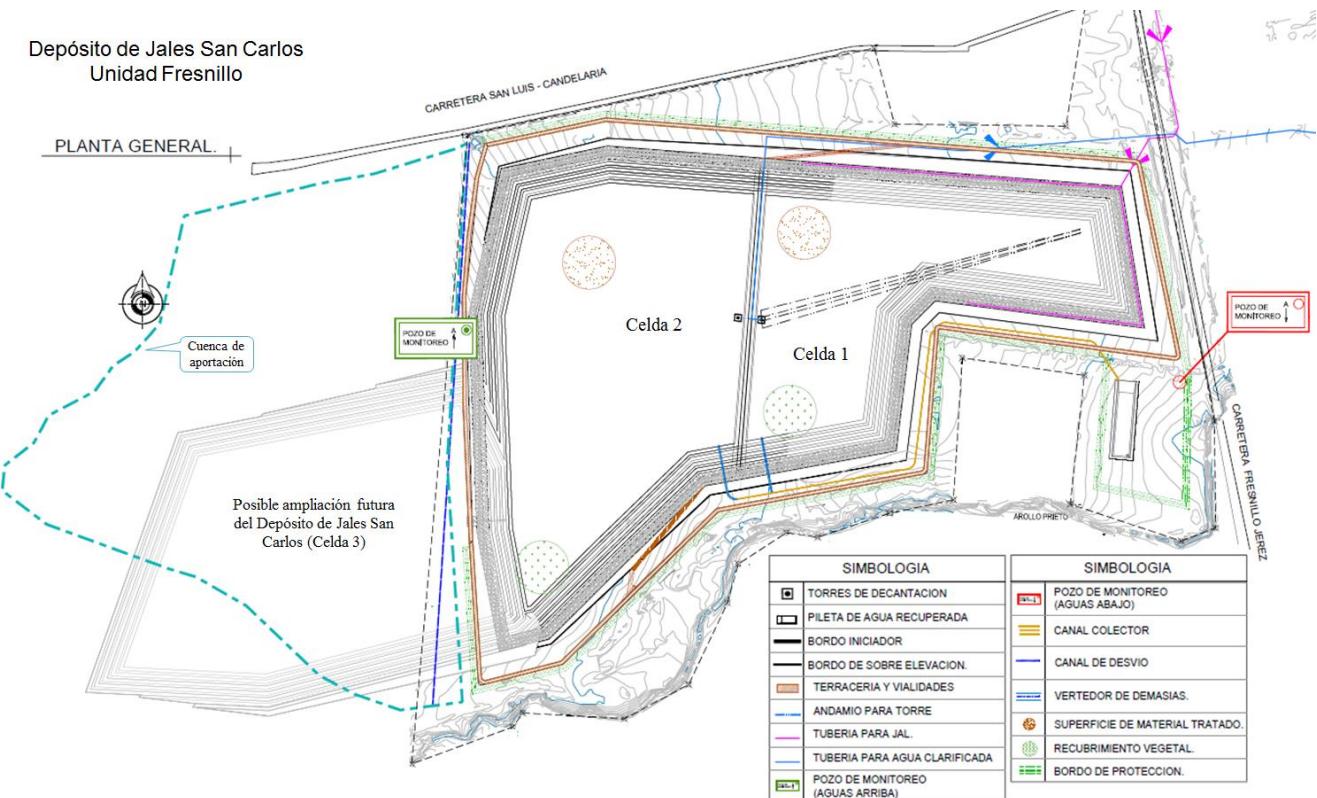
Planta general de las obras permanentes que integran al Proyecto
